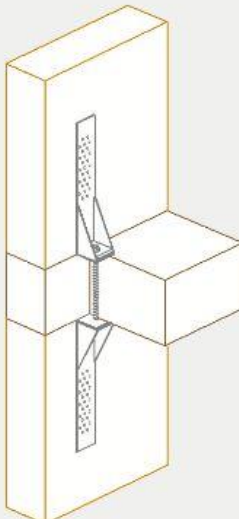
Ancoraggio interpiano a trazione WHT 440 Rothoblaas (software "TimberTech Buildings")
